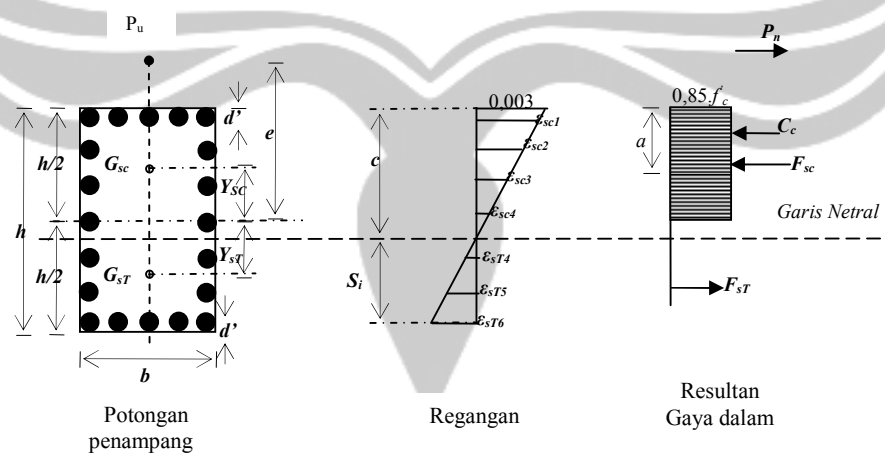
Diagram Regangan untuk Kegagalan Eksentrisitas Beban Kolom
